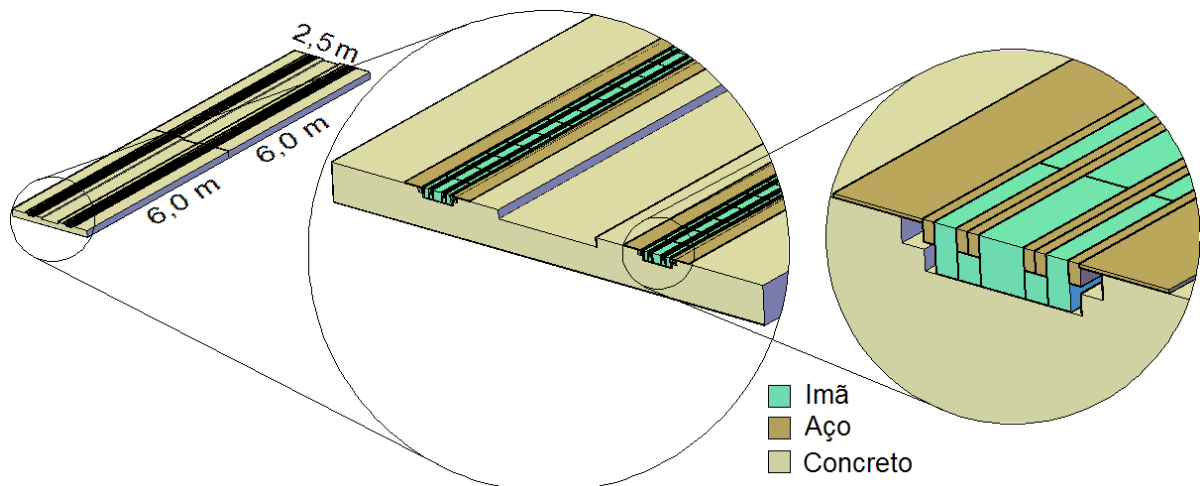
Lajes de concreto e detalhes da montagem dos ímãs.
